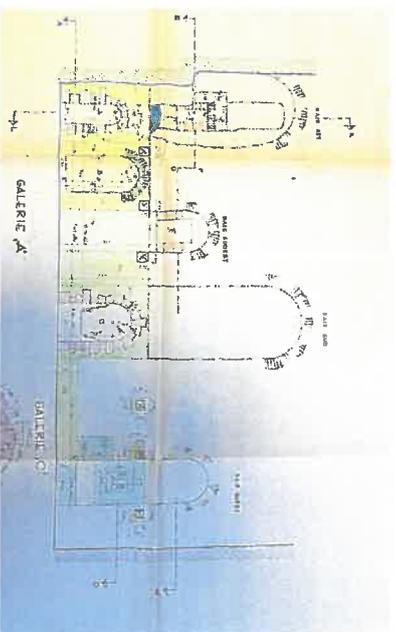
Reprise du parement extérieur et travaux en sous-sol, élévation intérieure développée, Cornon A.C.M.I.H, 1967 (source : UDAP 35).
